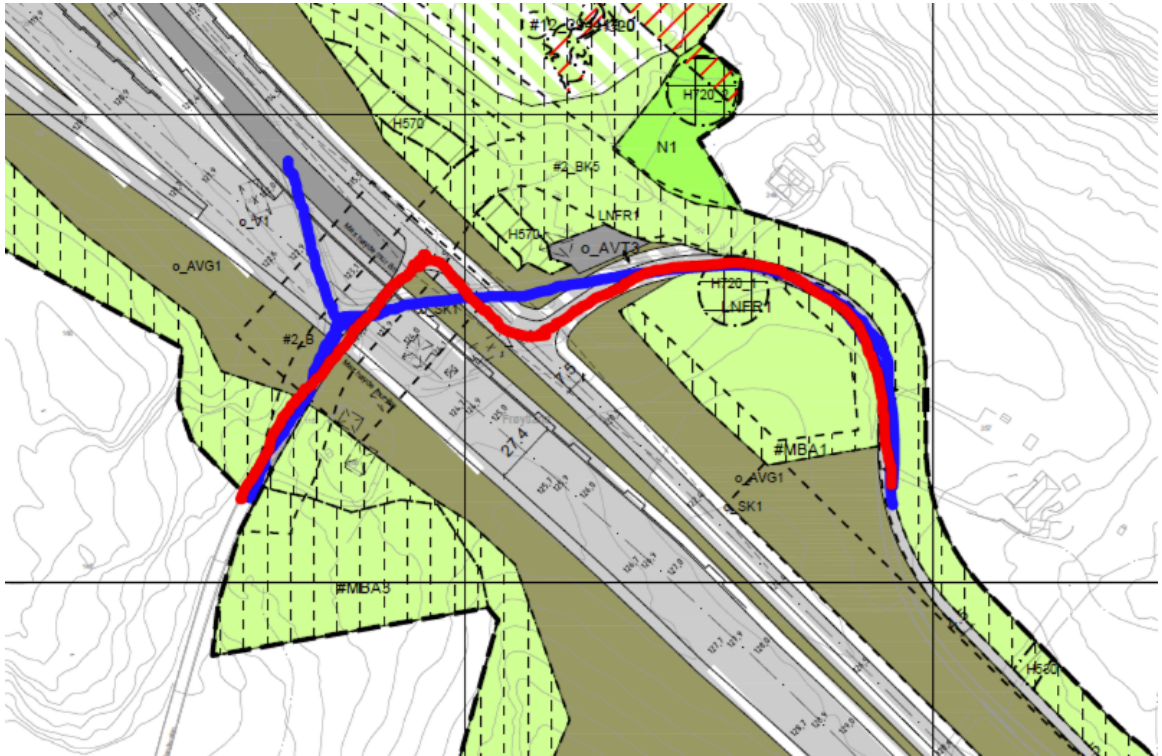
Blå linje, eksisterende kryss. Rød linje planlagt nytt kryss. Kulvert / tunnel under nye E39.
